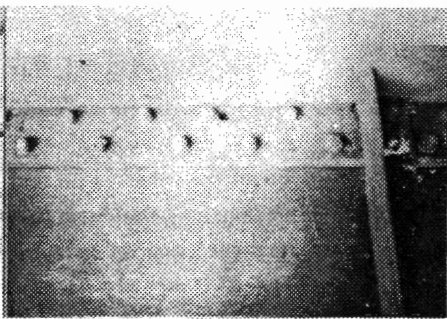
Erro de furação na cantoneira de um perfil composto. Observa-se o furo não preenchido.
